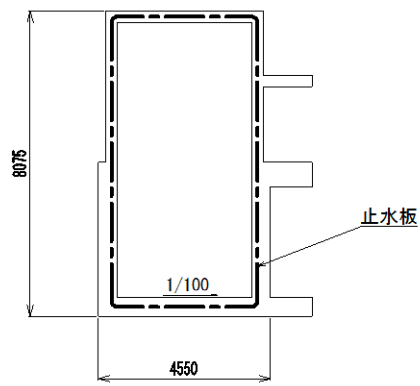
(4) トーラス水受入タンク遮蔽壁 概略配筋図 (弁室)
